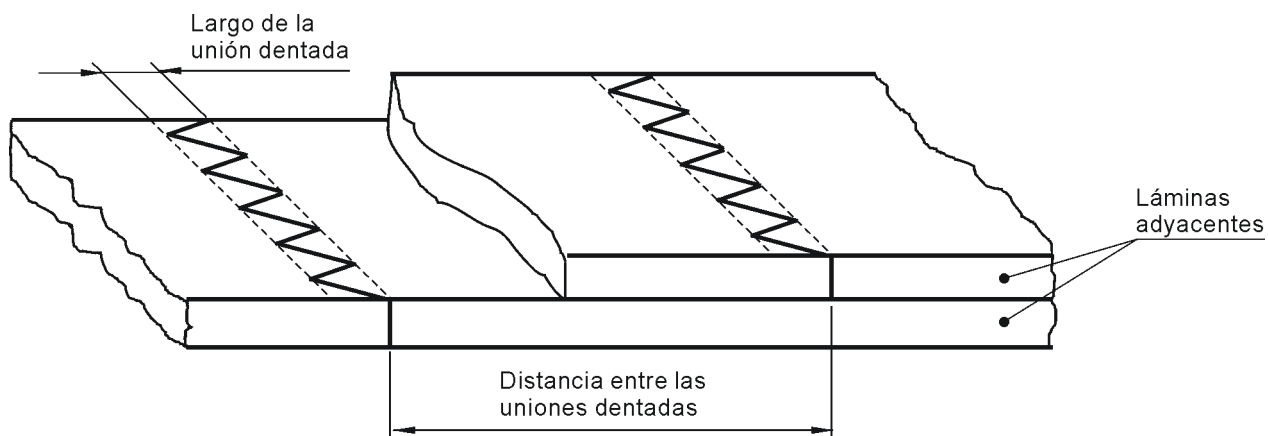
Distancia entre uniones de extremos en un elemento formado con láminas fabricadas con una pieza, en el ancho
